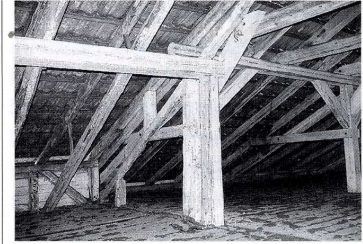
Links Dach des ehemaligen nördlichen Hammergebäudes mit Übergang zum südlichen ehemaligen Hammergebäude
